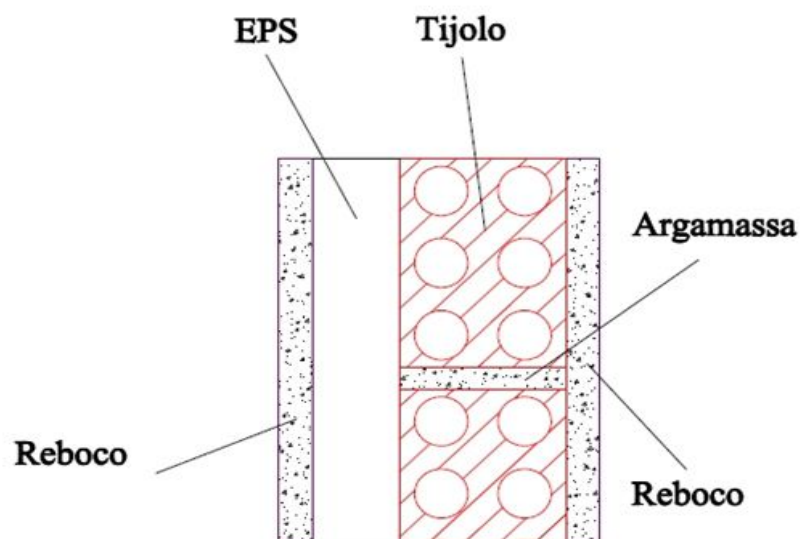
Parede simples com isolamento exterior de EPS (Adaptado de Berlofa 2009)
